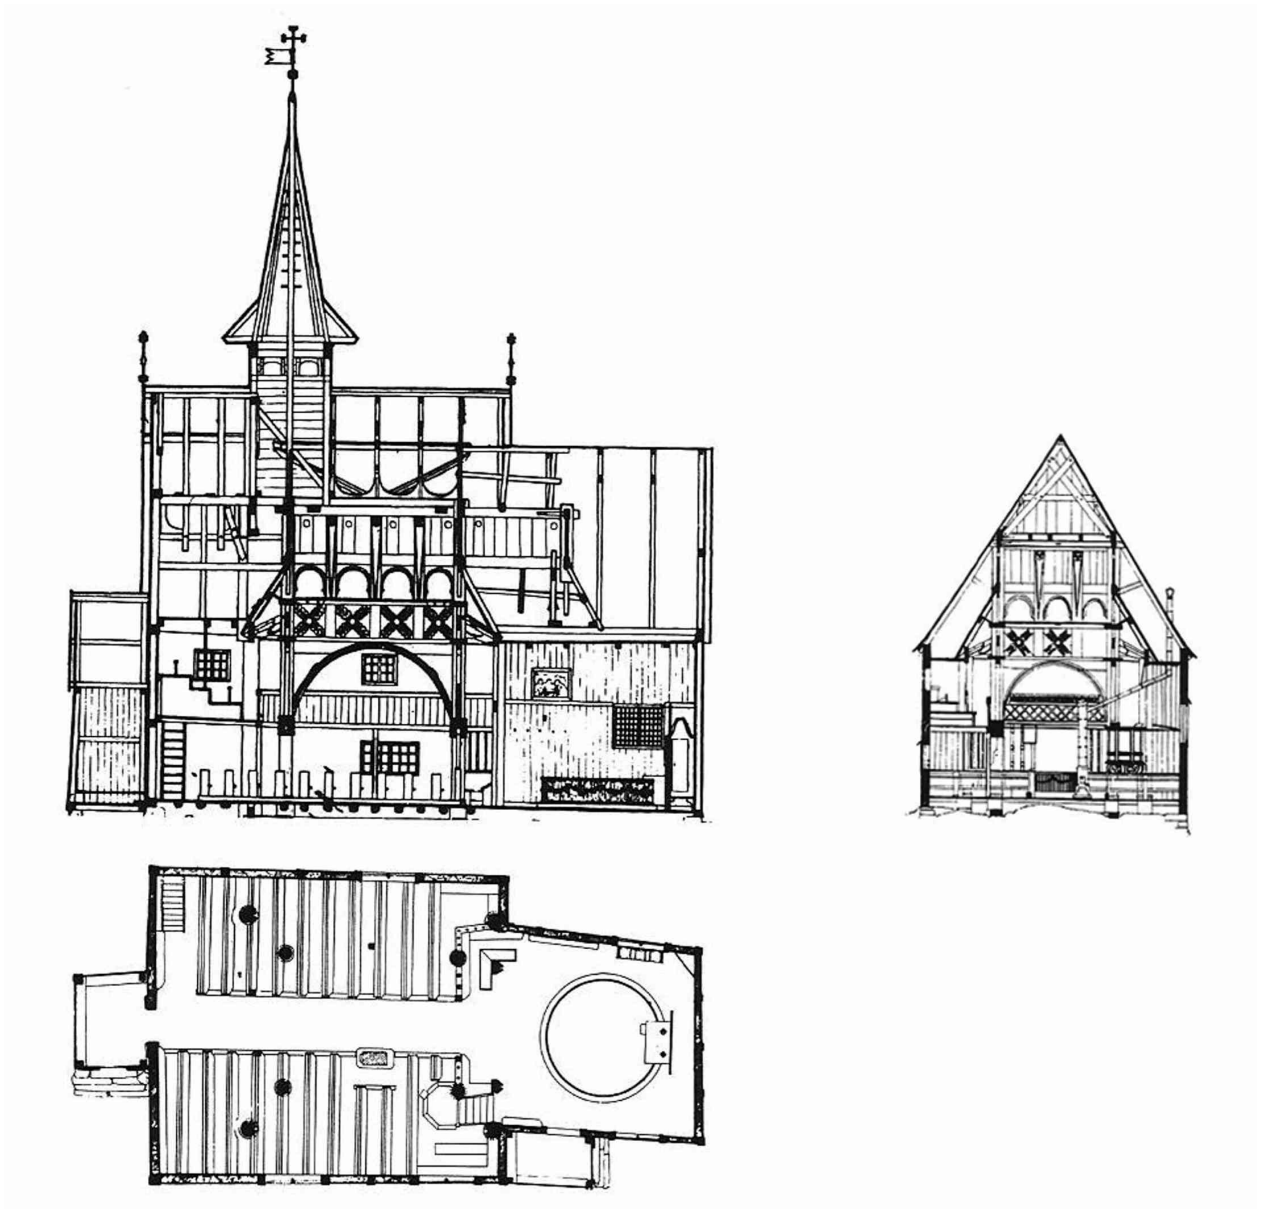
Stabkirche Lomen. Grundriss, Längsschnitt und Querschnitt. Quelle: Anker, Leif; Havran, Jiri: *The Norwegian Stave Churches*, Oslo 2005, S. 262.
